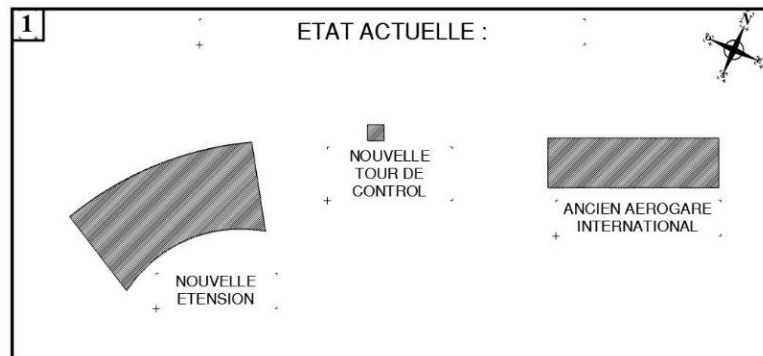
plan des interventions sur l'aéroport d'Oran - Ahmed Ben Bella
